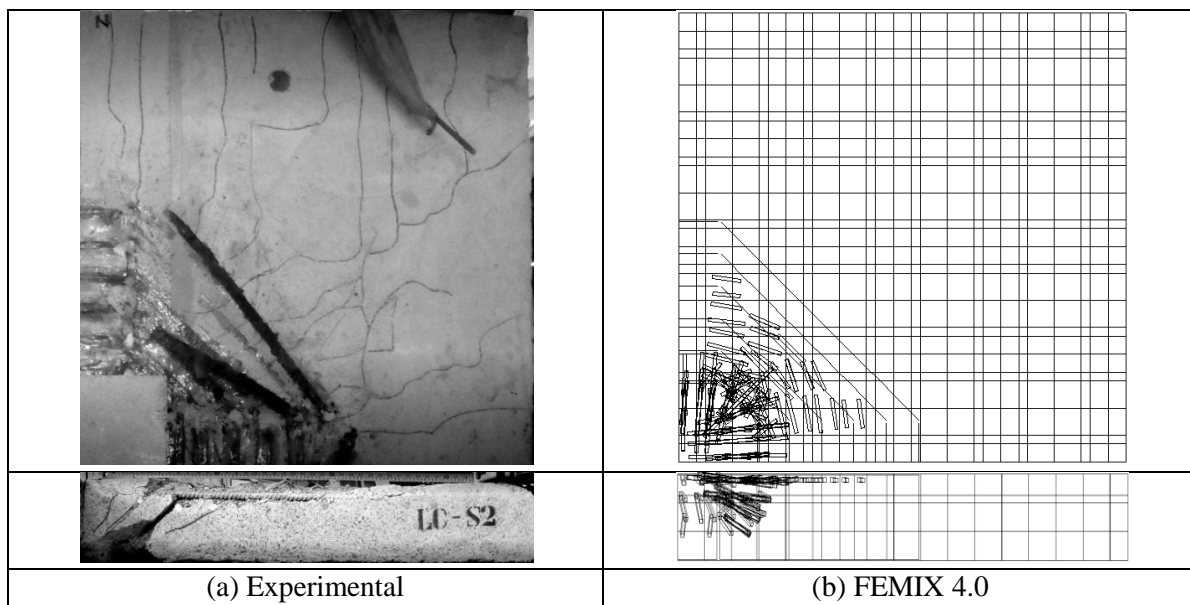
Padrão de fissuração - LC-S2 (FEMIX 4.0)
